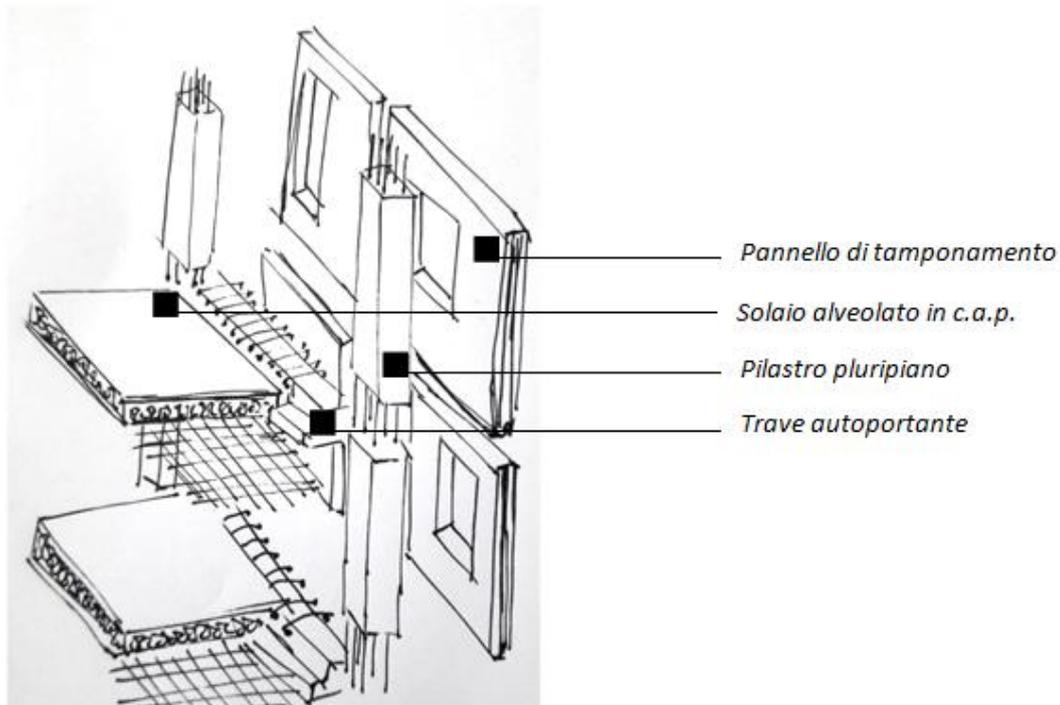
Struttura in elevazione. Elementi prefabbricati del progetto
